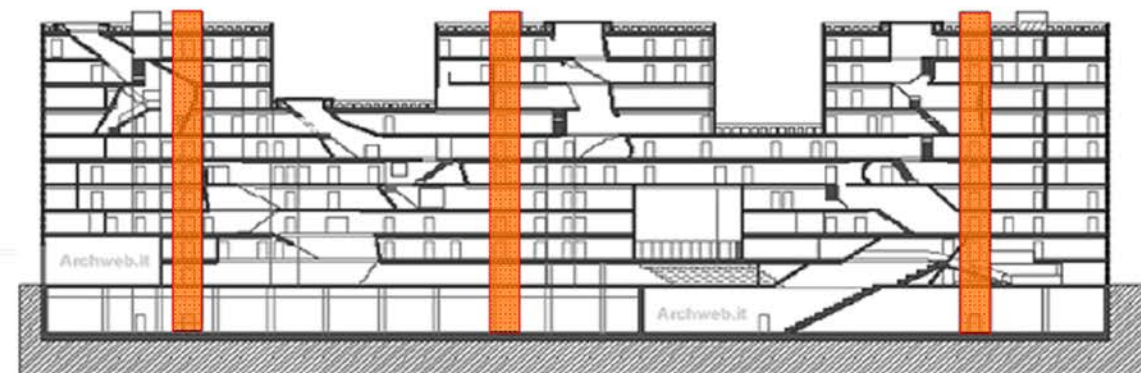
Circulación vertical de la residencia Simmons Hall. Fuente: <https://www.pinterest.com/pin/164029611400456795/>. Edición de imagen: Autores, 2014.
